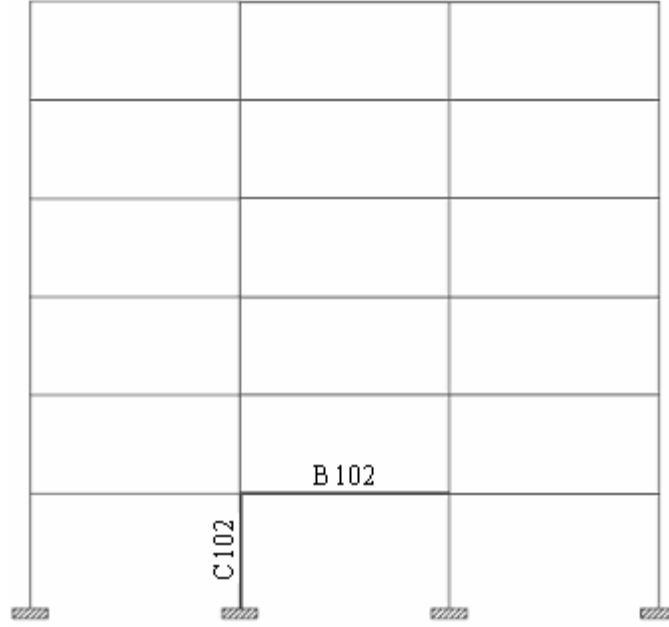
TSM-1 Kiriş – Kolon Boyutları ve Kolon Donatıları
